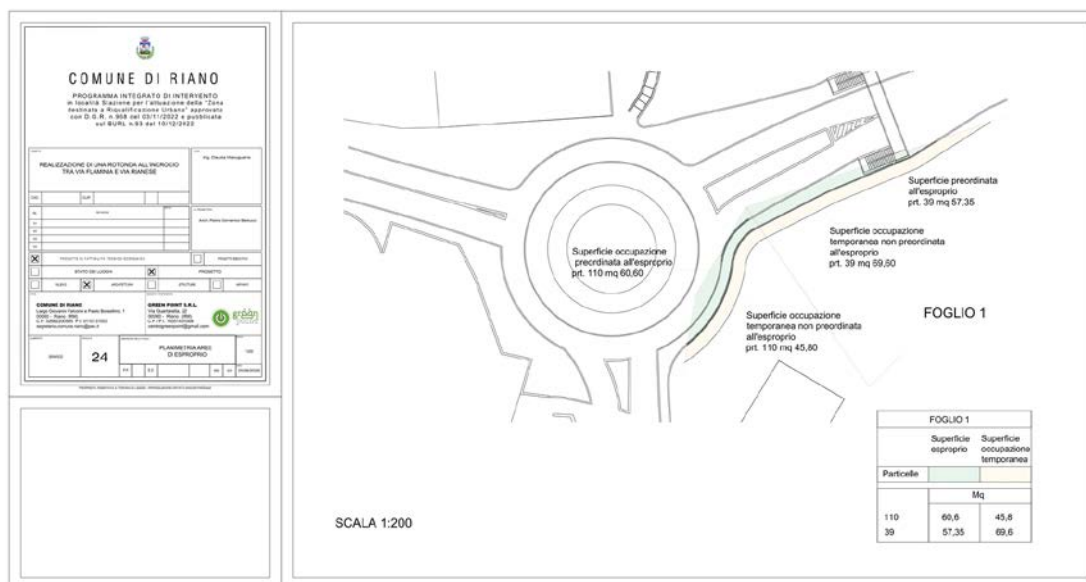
Estratto C24: planimetria aree di esproprio e occupazione temporanea.
